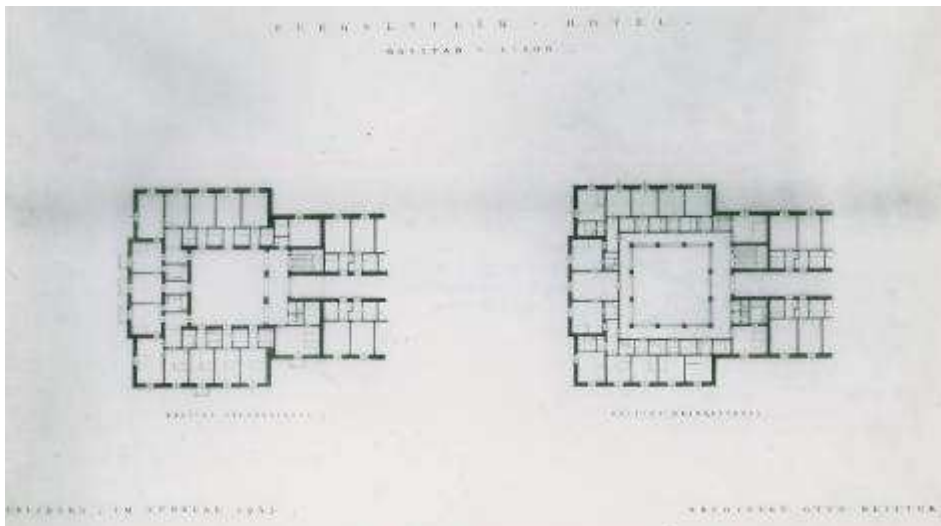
Otto Reitter, Grundrisse, 2. und 3. Obergeschoss, *Bürgelstein-Hotel*, Salzburg, Februar 1943 (Sammlung Ostheim).
